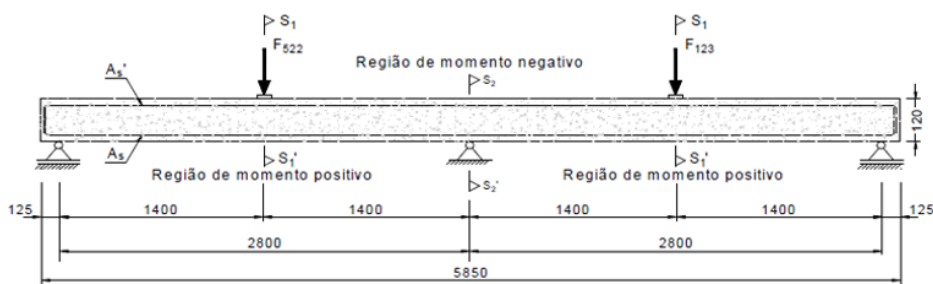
Geometria das faixas de laje ensaiadas por Dalfr\ê e Barros (2012).
